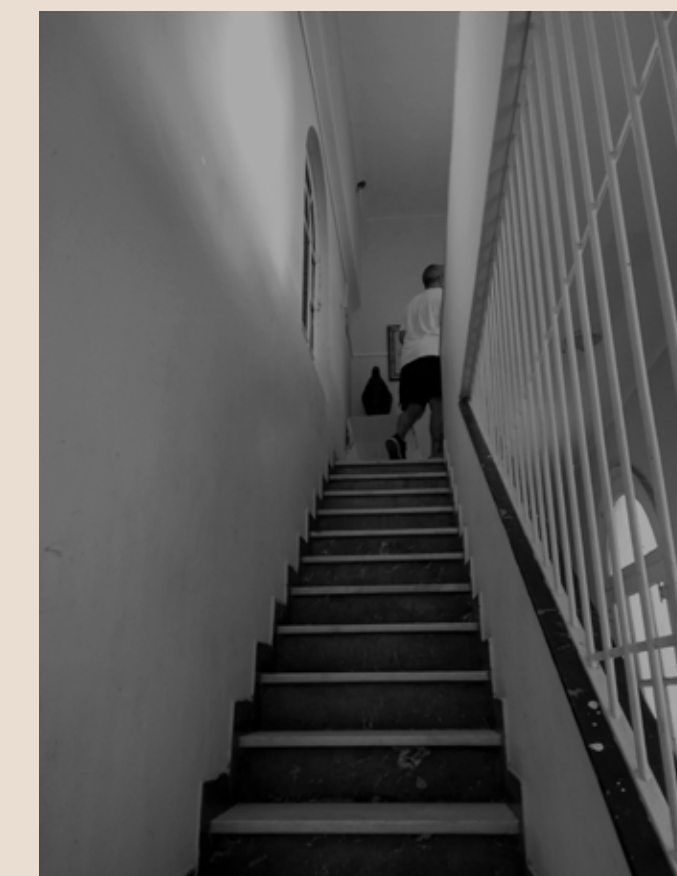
Escada para o segundo pavimento. Fonte: Autoria própria, 2021.
